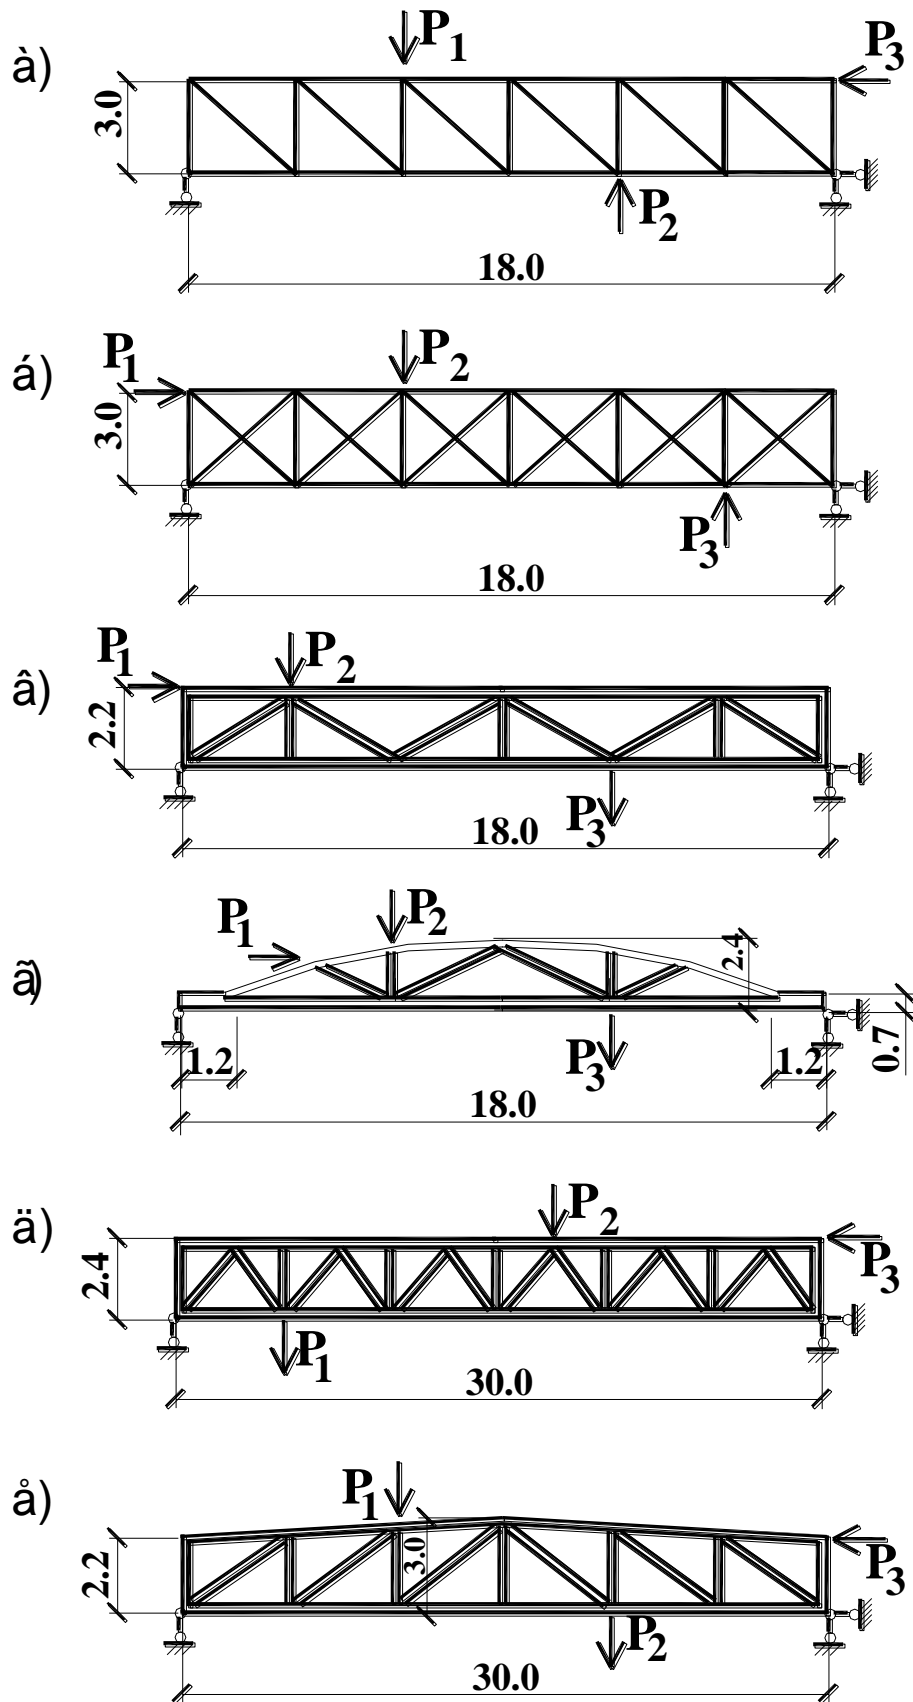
Розрахункові схеми крокв'яних ферм покриття.
